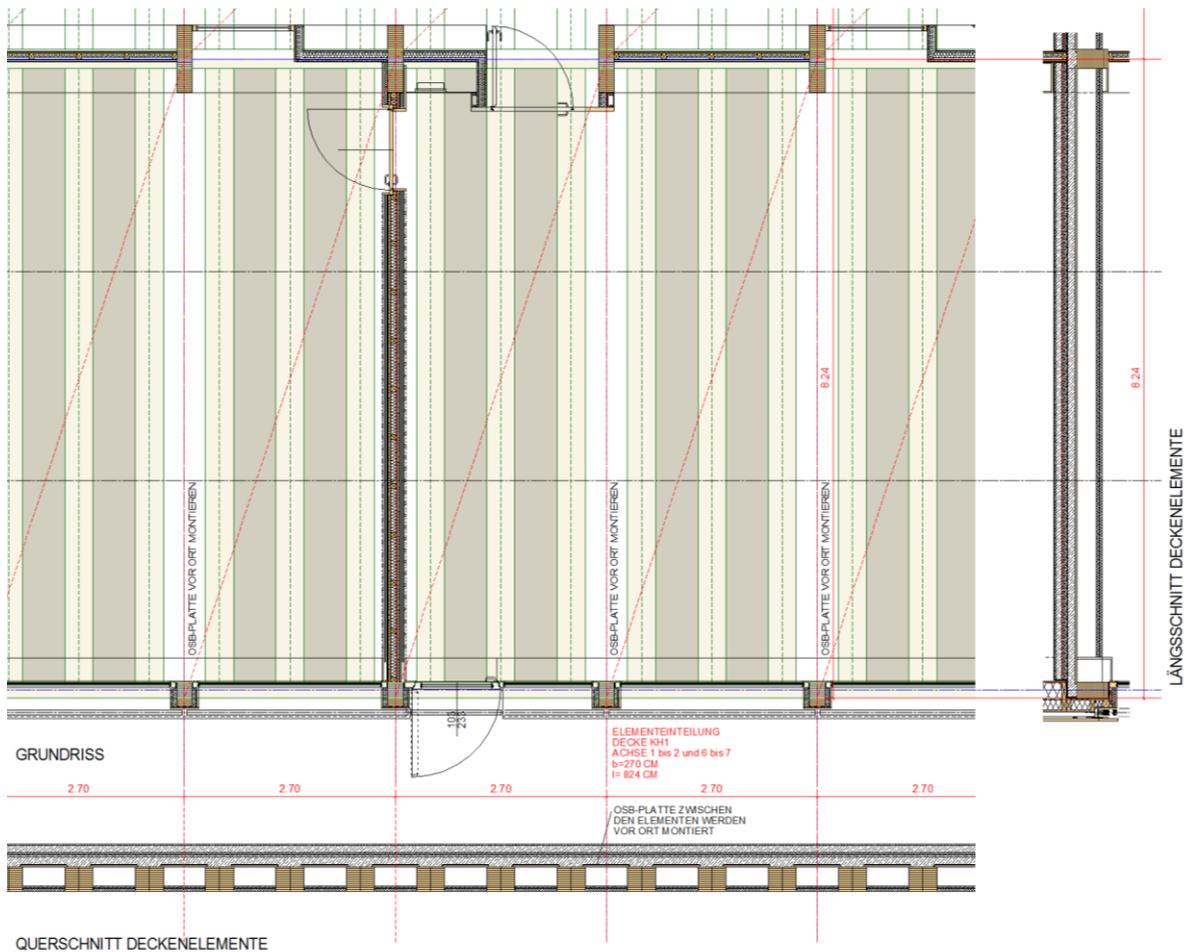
beispielhafte Darstellungen der Elementeteilung der Decken des KH I im Grundriss, Quer- und Längsschnitt
